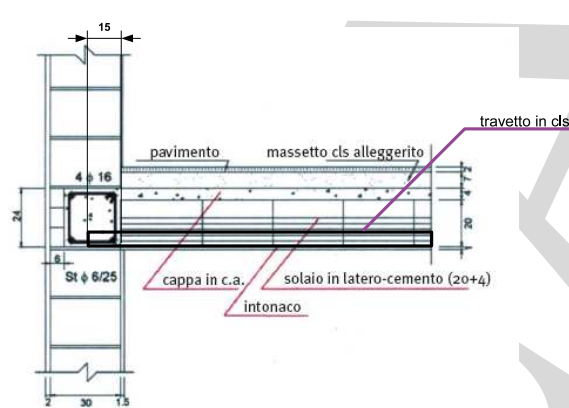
Giunzione solaio-muro portante. Si noti la profondità di appoggio dei travetti. Sarebbe stato consigliabile arretrare i laterizi (fascia piena).
